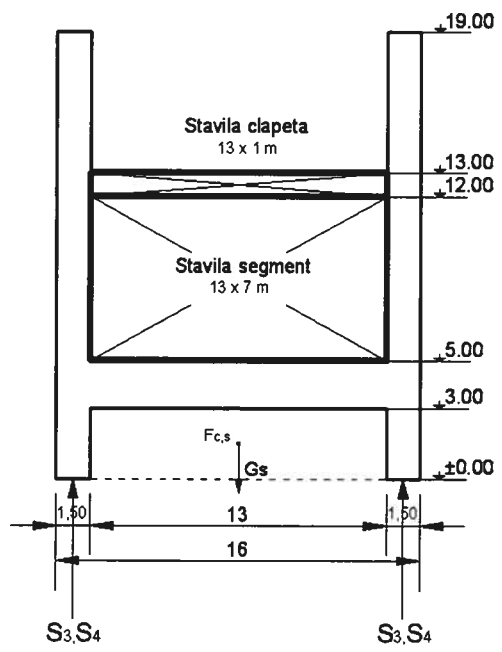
Elemente geometrice și schema încărcărilor pentru verificarea profilului stavelor
